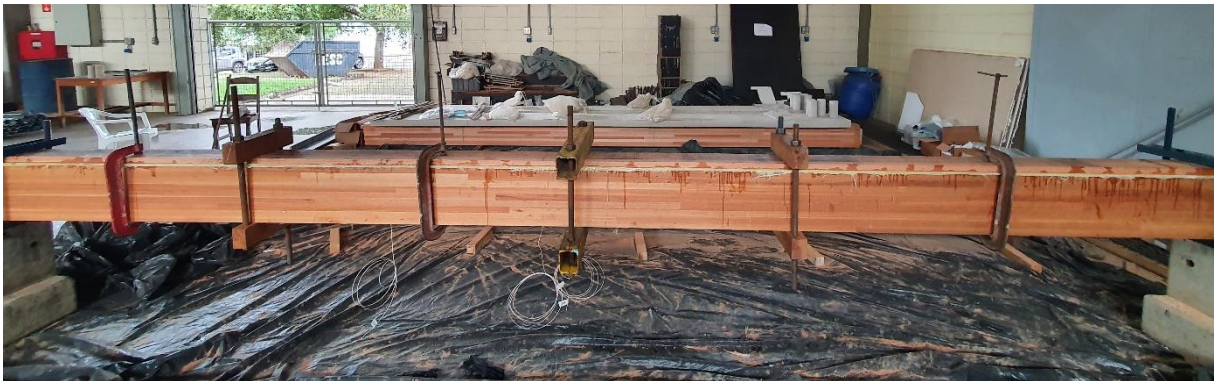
Viga de madeira Reforçada com fibras de vidro
